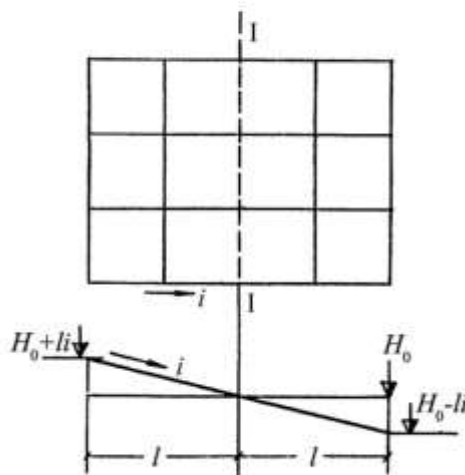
К определению красных отметок при планировке площадки с уклоном
